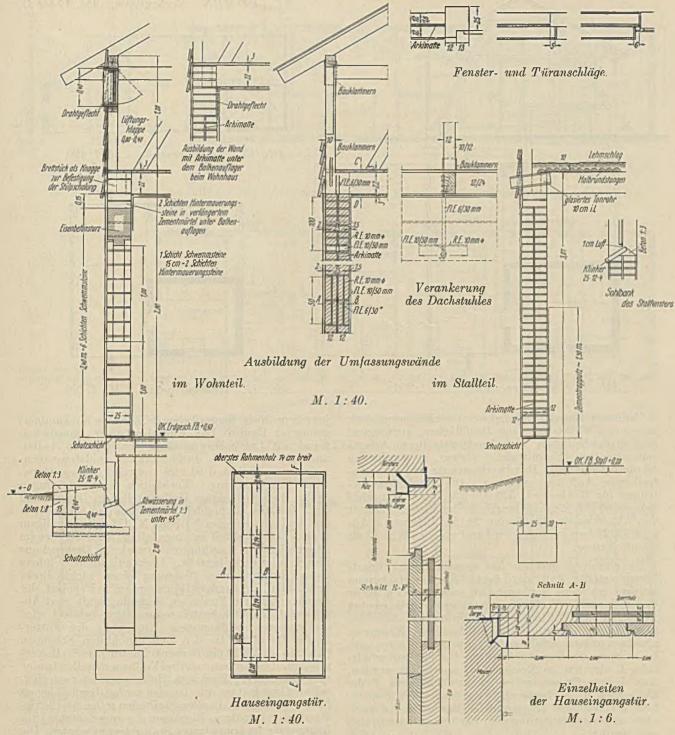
Einzelheiten der Ausführung bei Wohnhaus- und Stallneubauten.
